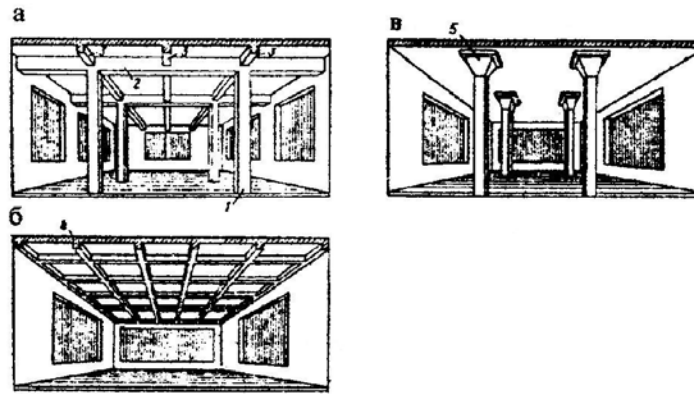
Міжповерхові перекриття громадських будівель:
